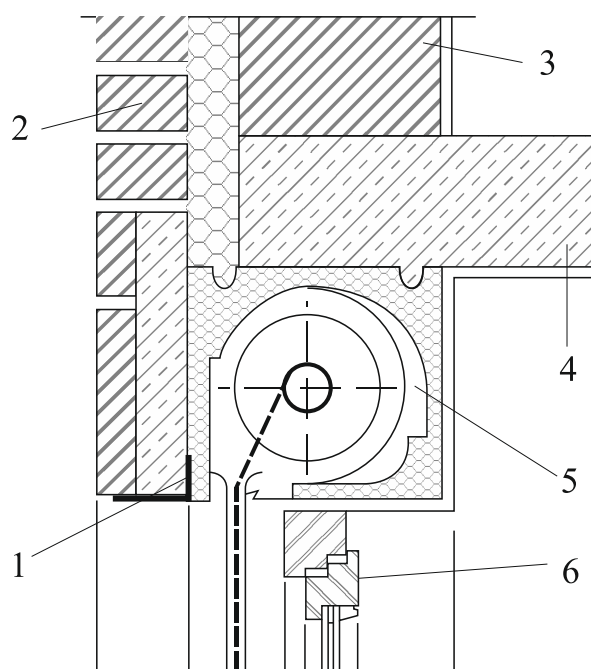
Устройство перемычки в лицевом слое в виде уголкового металлических консолей, закрепленных к железобетонным перекрытиям [34]
